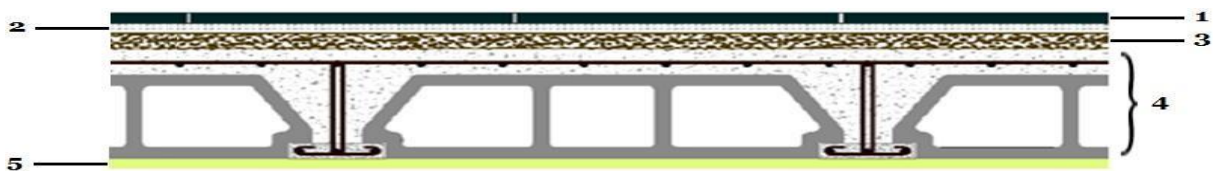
Coupe transversale d'un plancher à corps creux d'étage courant.
